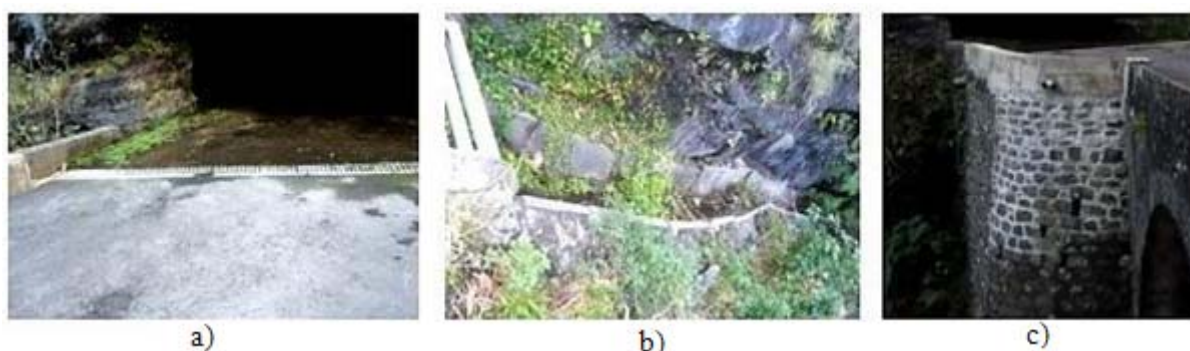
Última intervenção: a) Prolongamento da caleira à existente; b) Construção da Valeta; c) Restabelecimento do muro Nordeste (Novembro de 2013).
